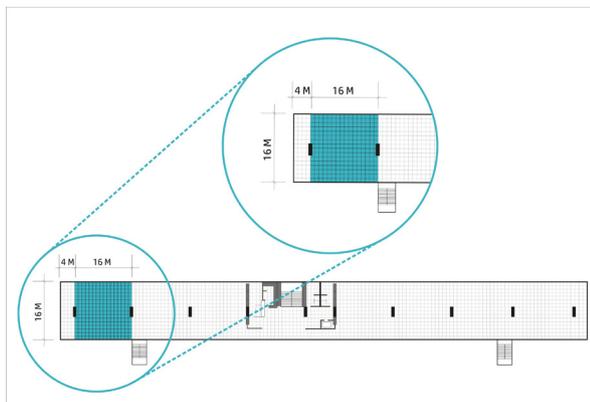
Planta Baixa do Pavimento Tipo do edifício E1 - Modulação e cotas. Fonte: AUTOR (2018) com base em PUSP-SC (2017).
